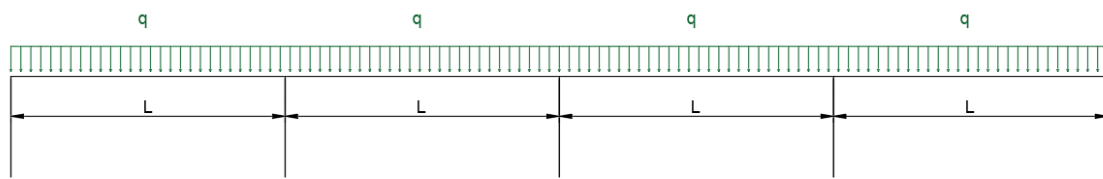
Cargas y luces de los vanos sin pico de lanzamiento.
